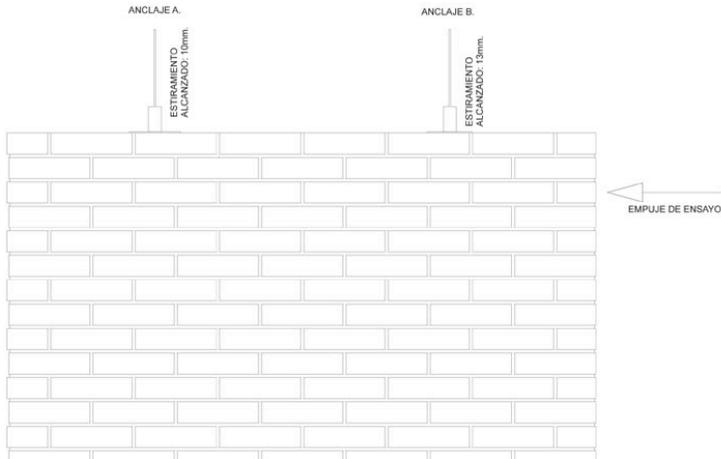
Proceso de tensado de muro de ladrillo panelón.
